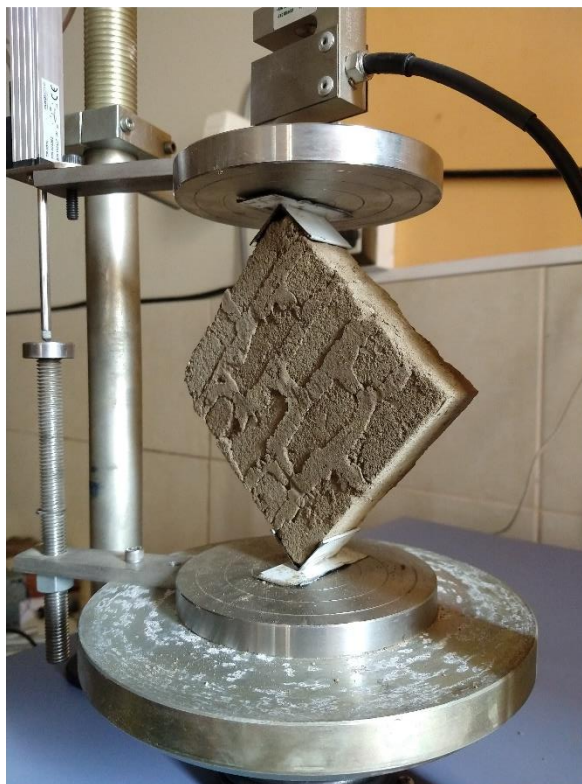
Instalación de murete de adobe para ensayo a tracción diagonal
